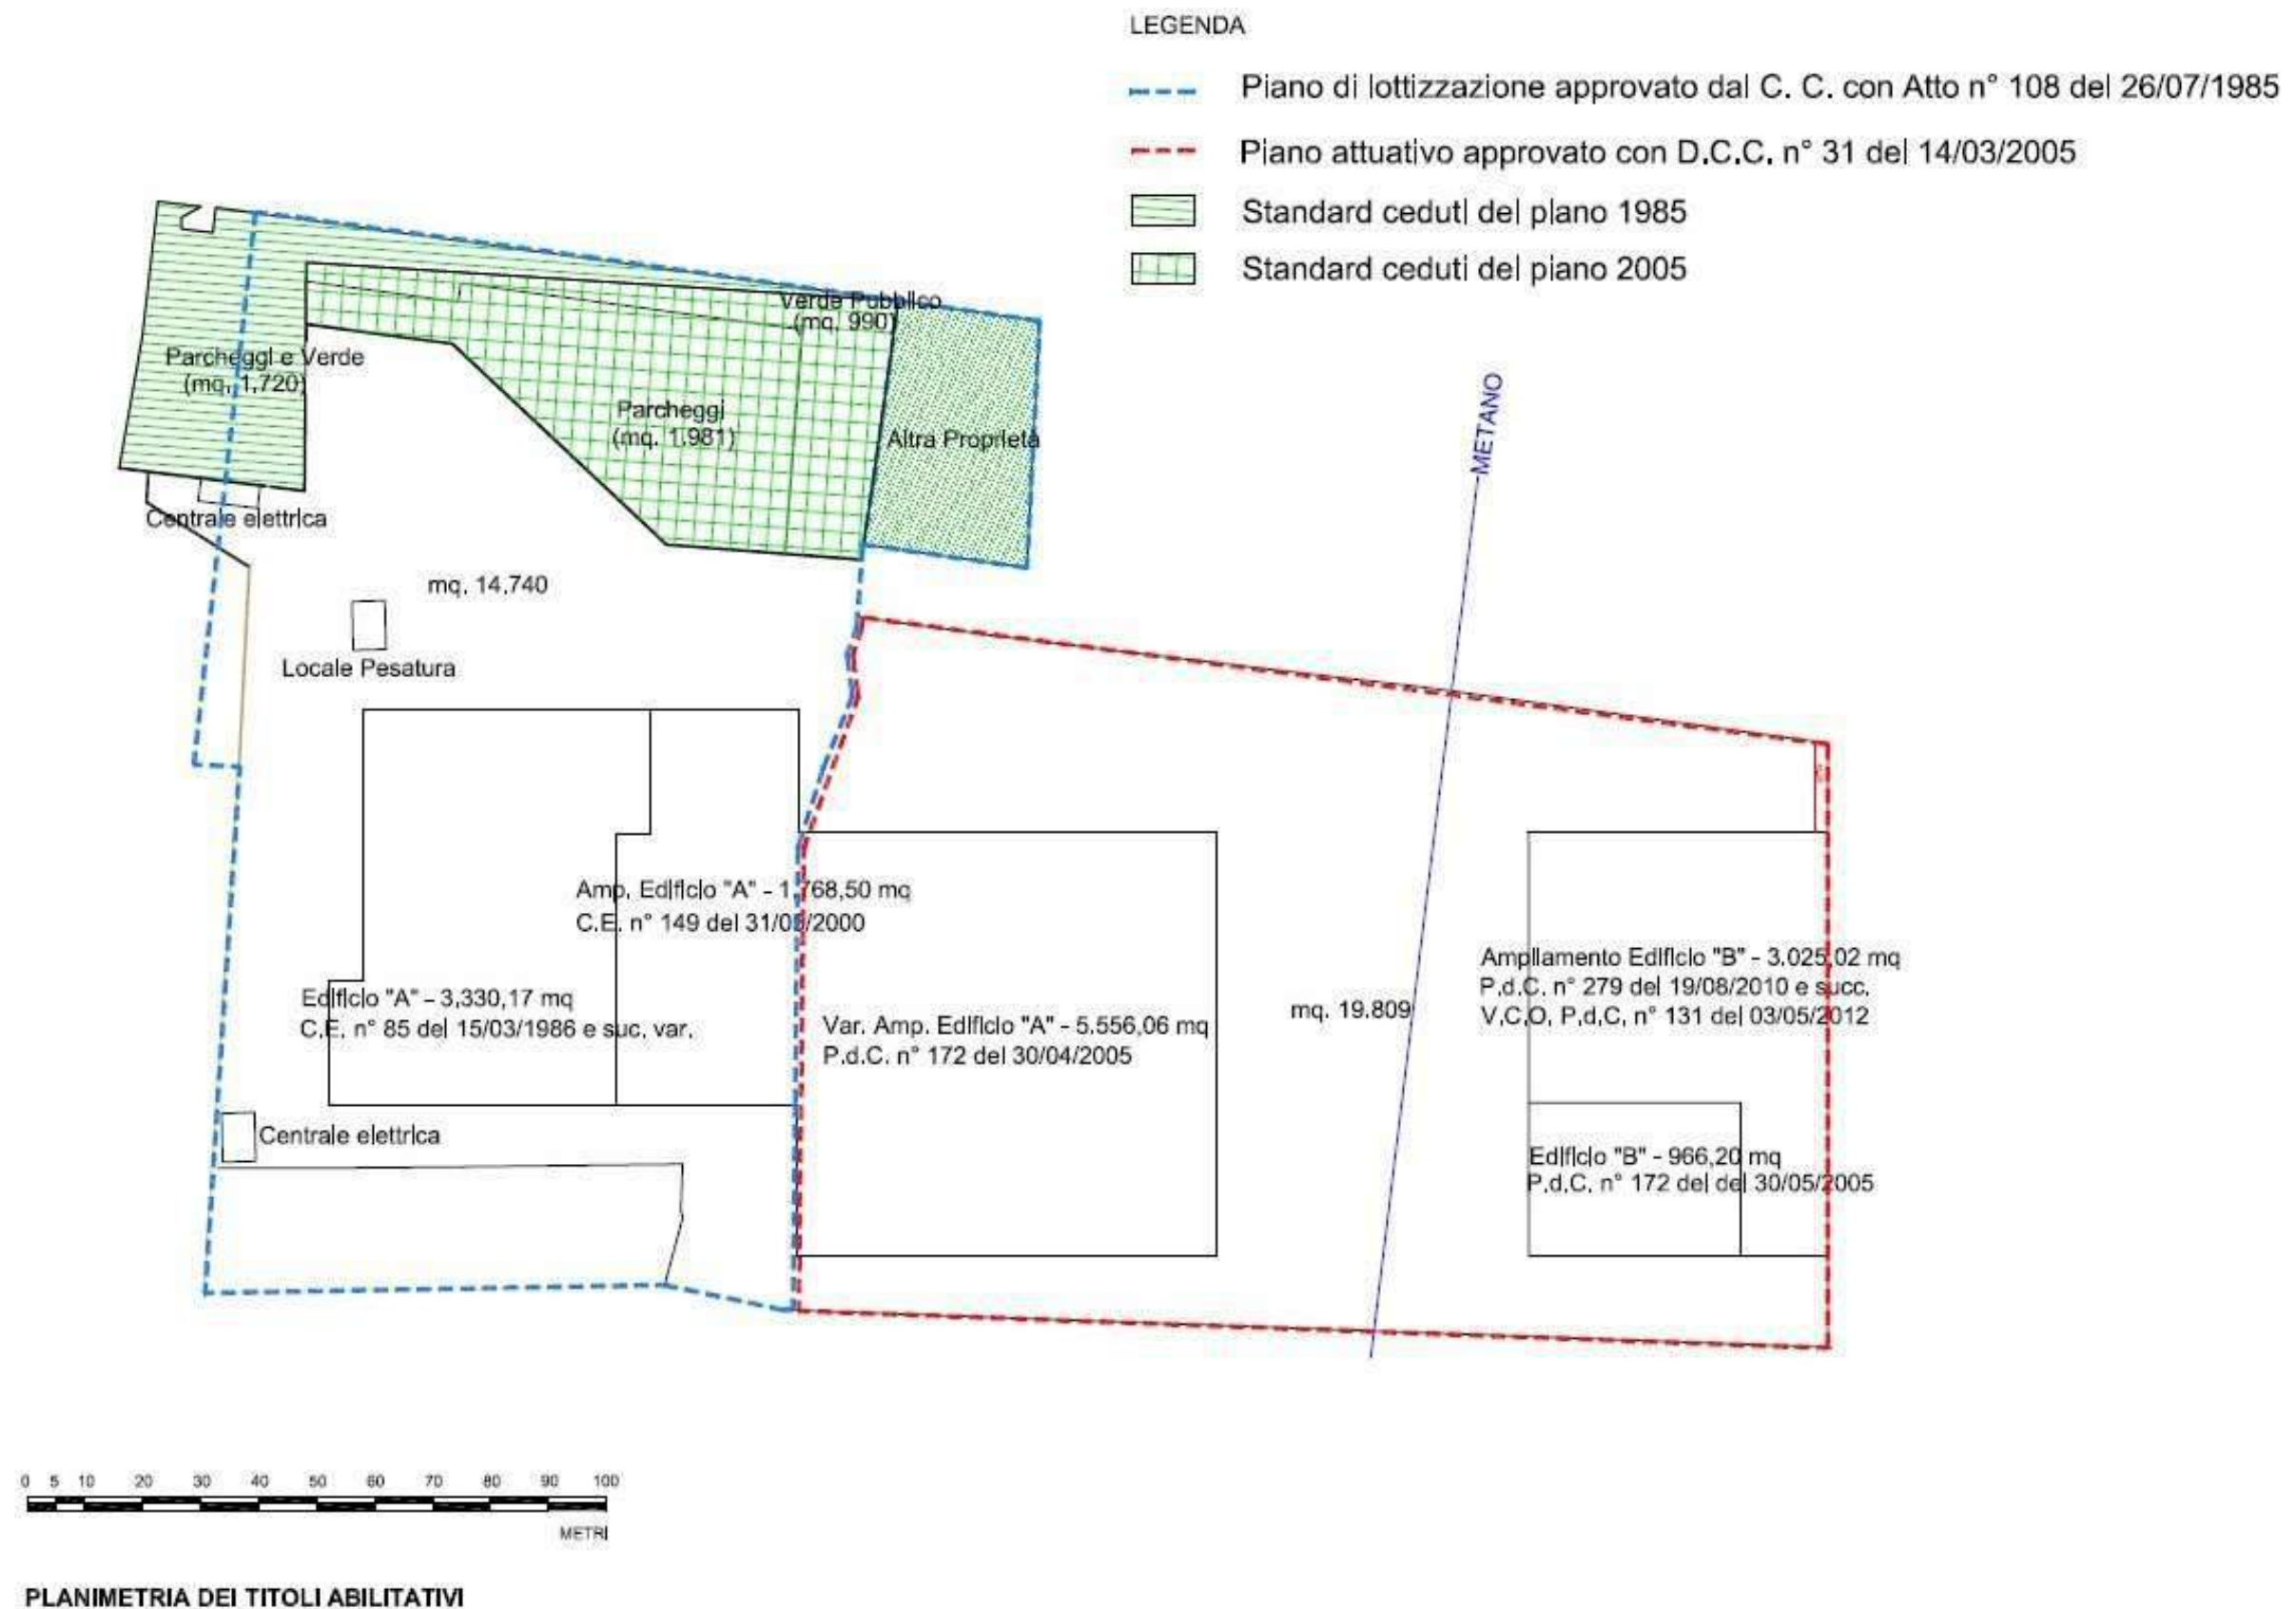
Planimetria attuale con individuazione dei piani attuativi
